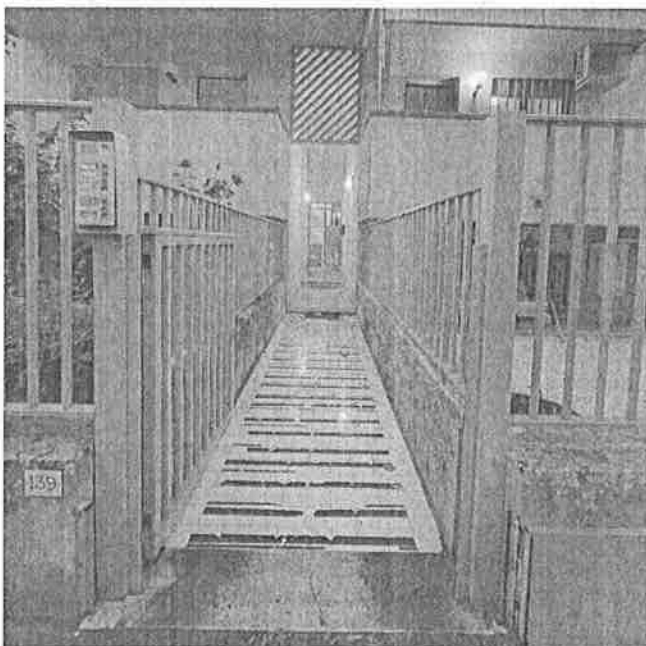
Ingresso al vano scala condominiale piano terra
